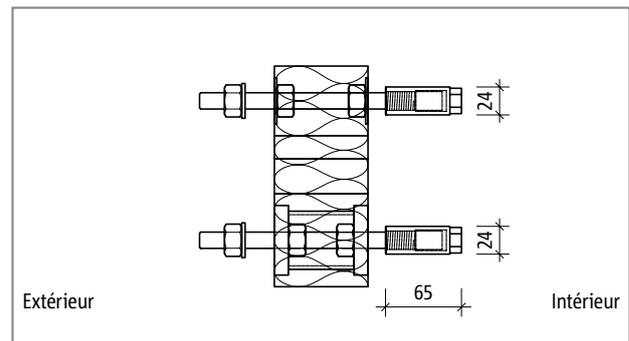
Schöck Isokorb® T type S avec écrous borgnes : coupe du produit
